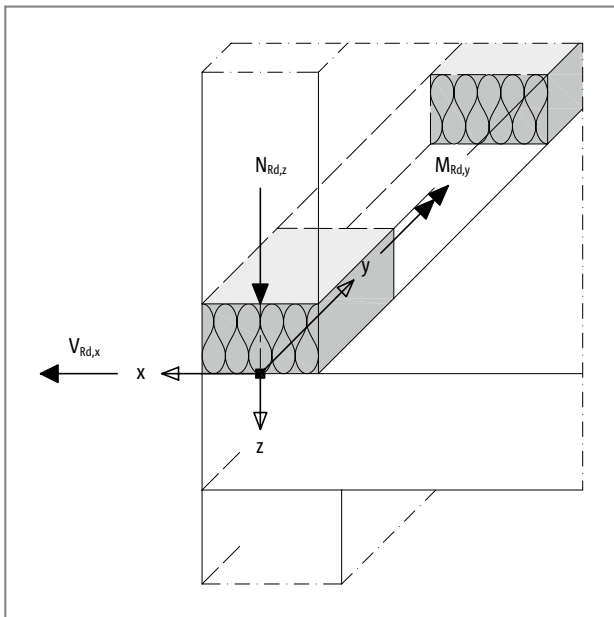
Schöck Isokorb® T tipo AP: regola dei segni per il calcolo di parapetti sovrapposti
